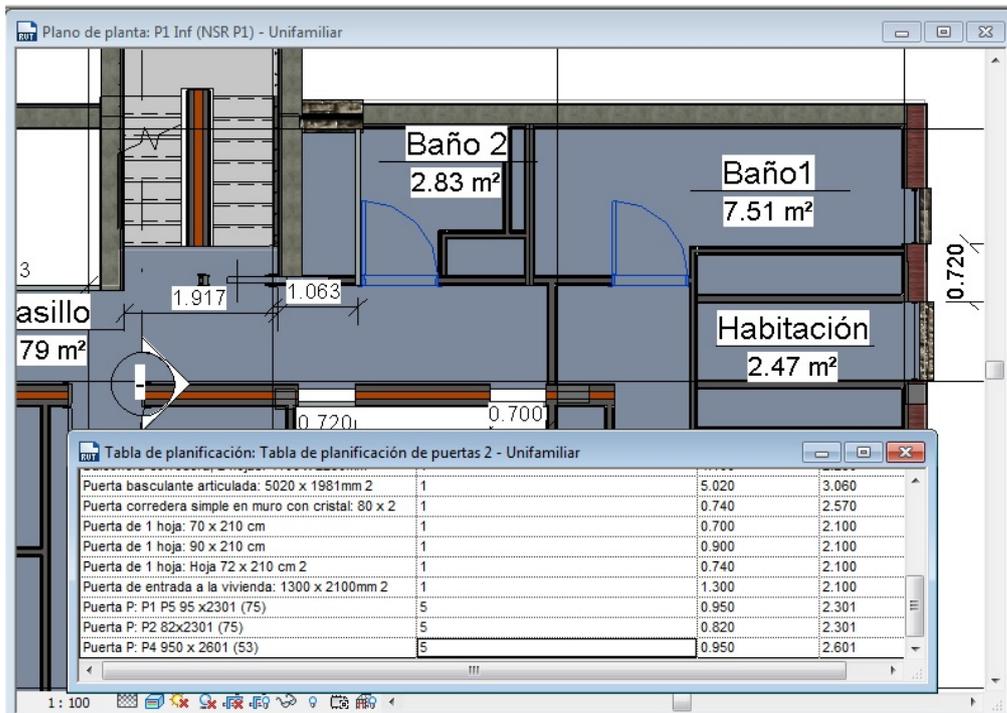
Modelo en Revit dónde aparece la tabla de planificación de puertas y remarcados los ejemplares en concreto. (Fuente propia)
